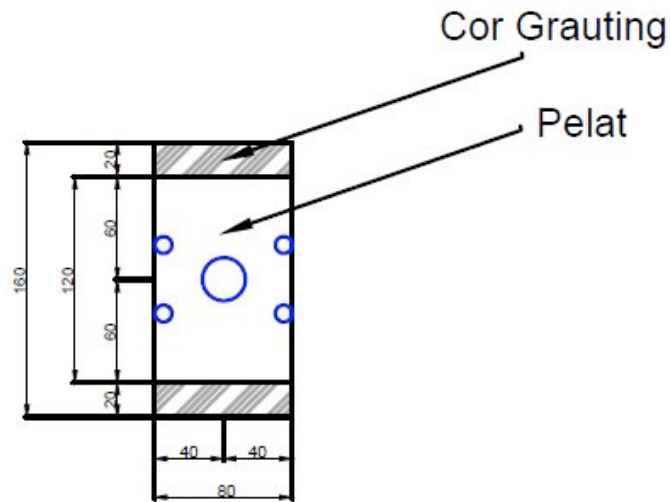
Desain Penulangan Kuda-Kuda Beton Komposit Tulangan Bambu
